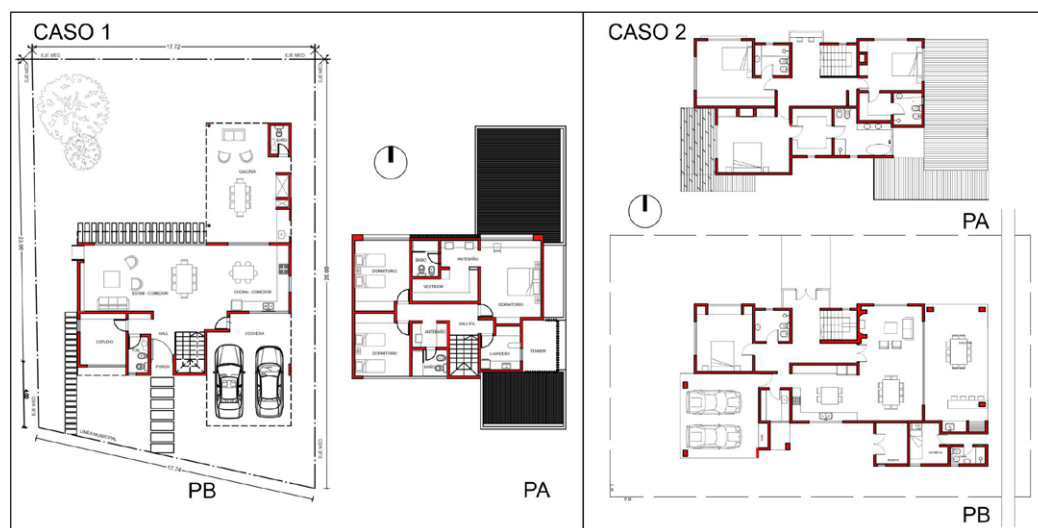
| Planimetría de ambos casos de estudio. Fuente: elaboración propia.
